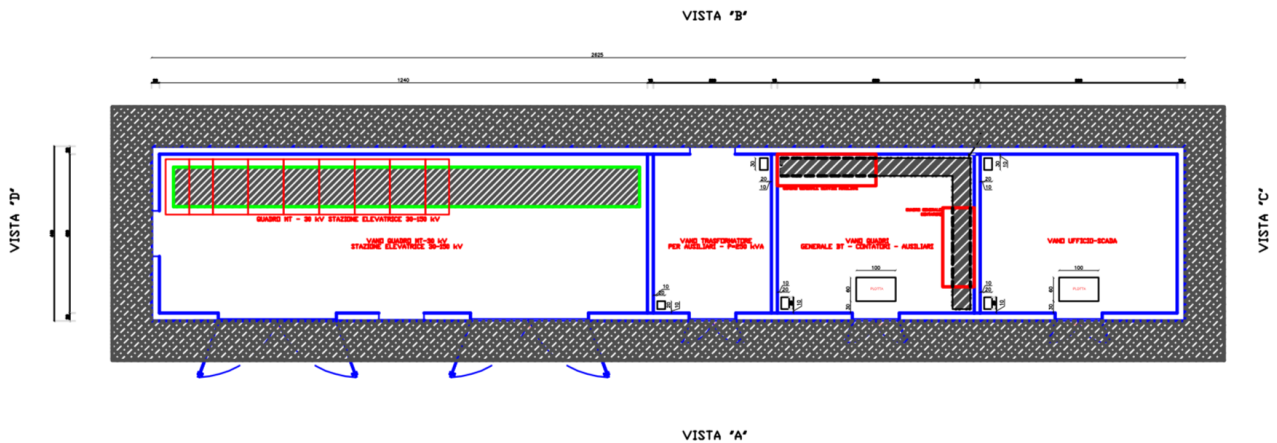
Layout cabina stazione elevatrice 30-150 kV
